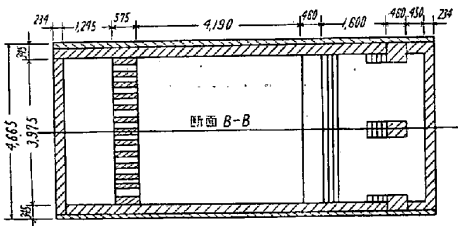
B. 空気予熱器 element 及 tube brick element 配置図
